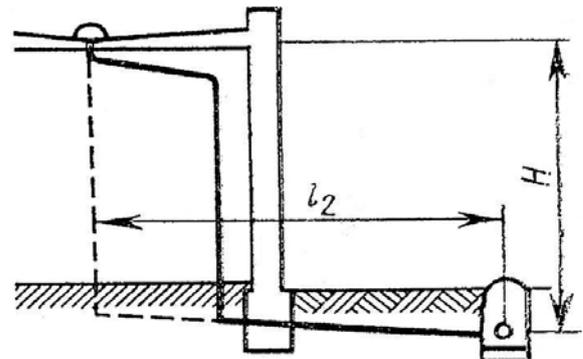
Схема внутрішнього дощового водоскиду з однією воронкою на стояку з підвісним трубопроводом.
